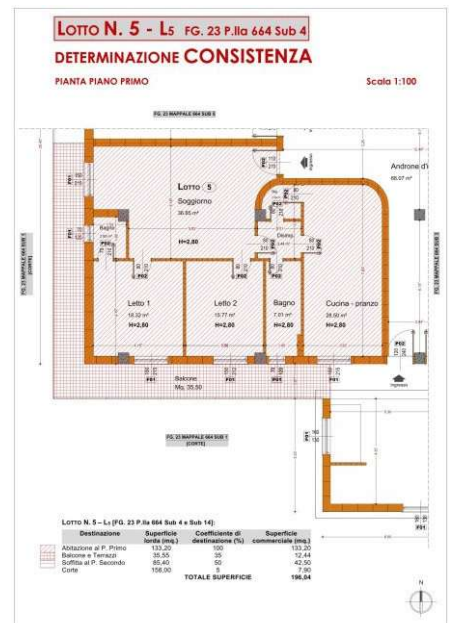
Determinazione consistenza Lotto L₅ (ALL. 11).
